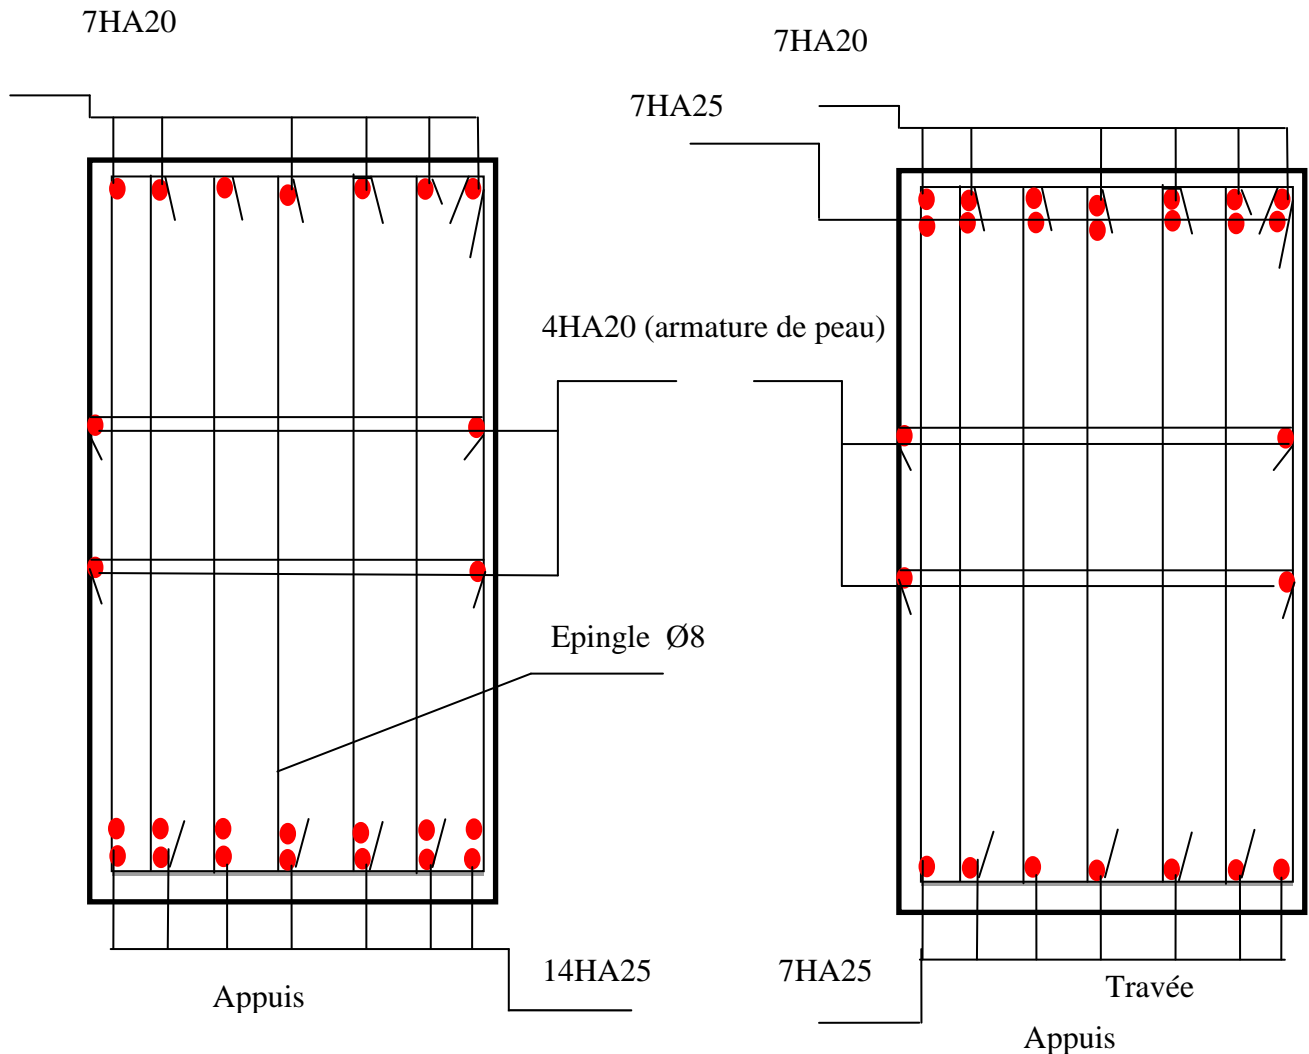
schéma de ferrailage des nervures sens X-X
